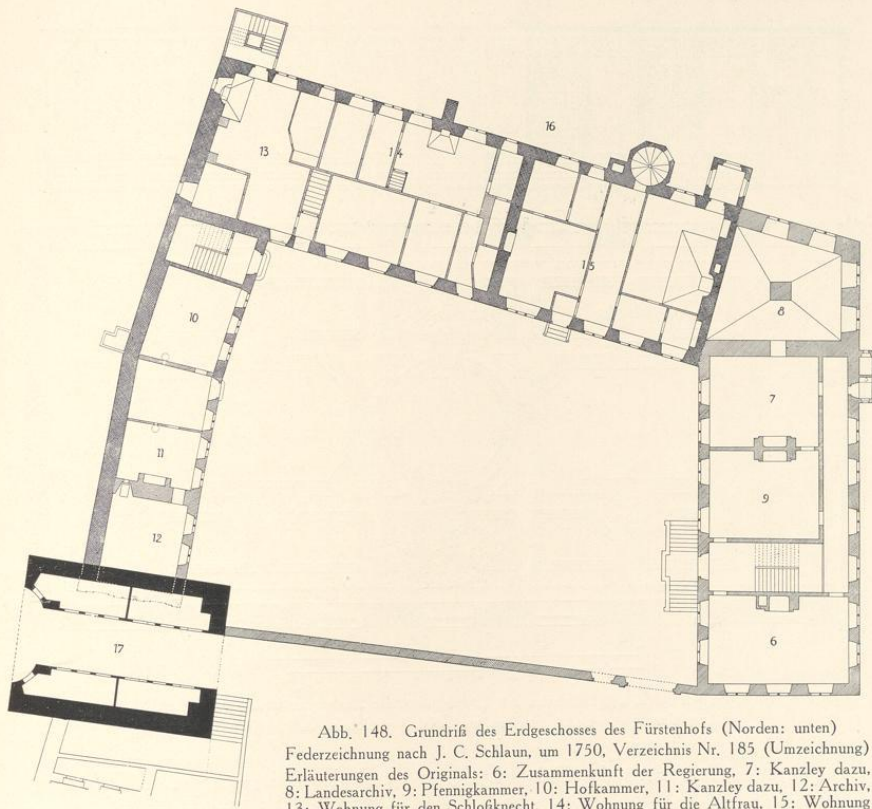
Grundriß des Erdgeschosses des Fürstenhofs (Norden: unten)
